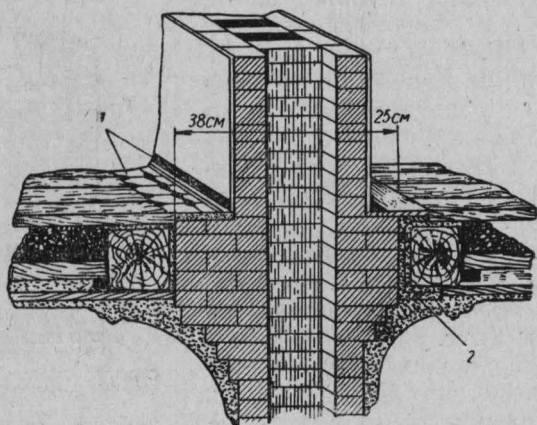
Разделка от дымохода до деревянных конструкций перекрытия:
